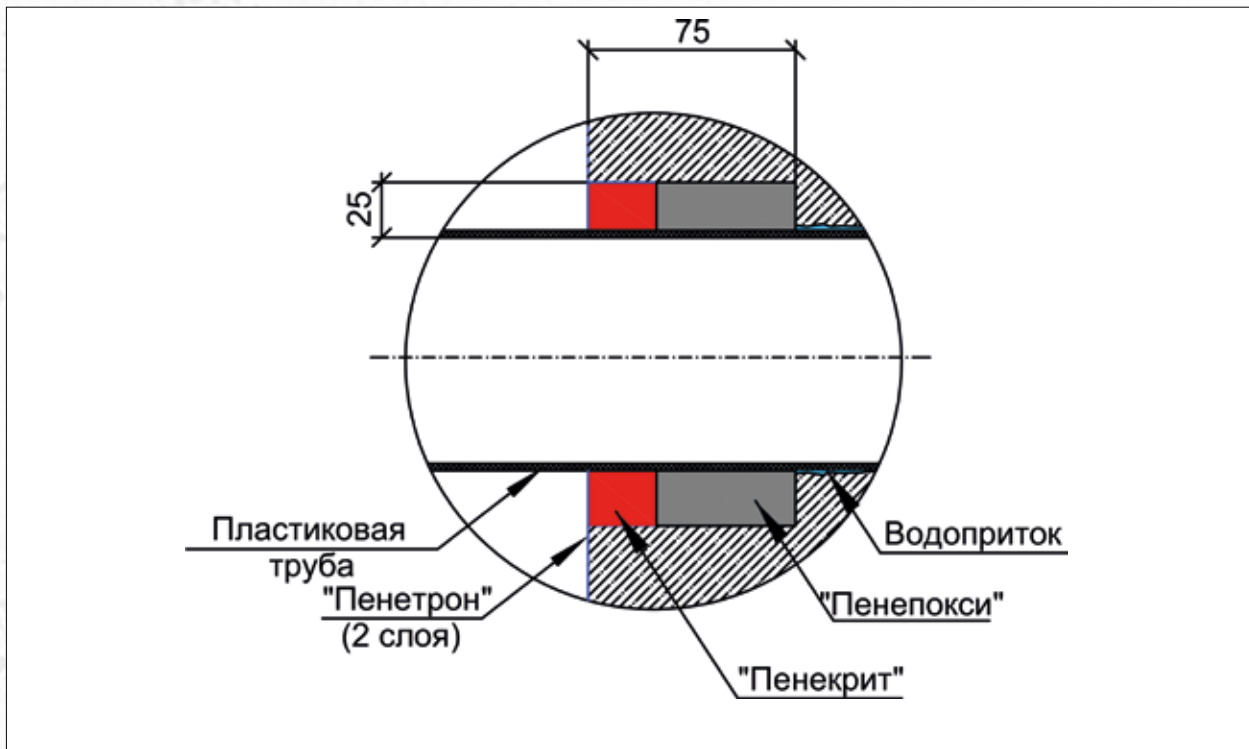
Гидроизоляция примыкания пластиковой гильзы к бетону
